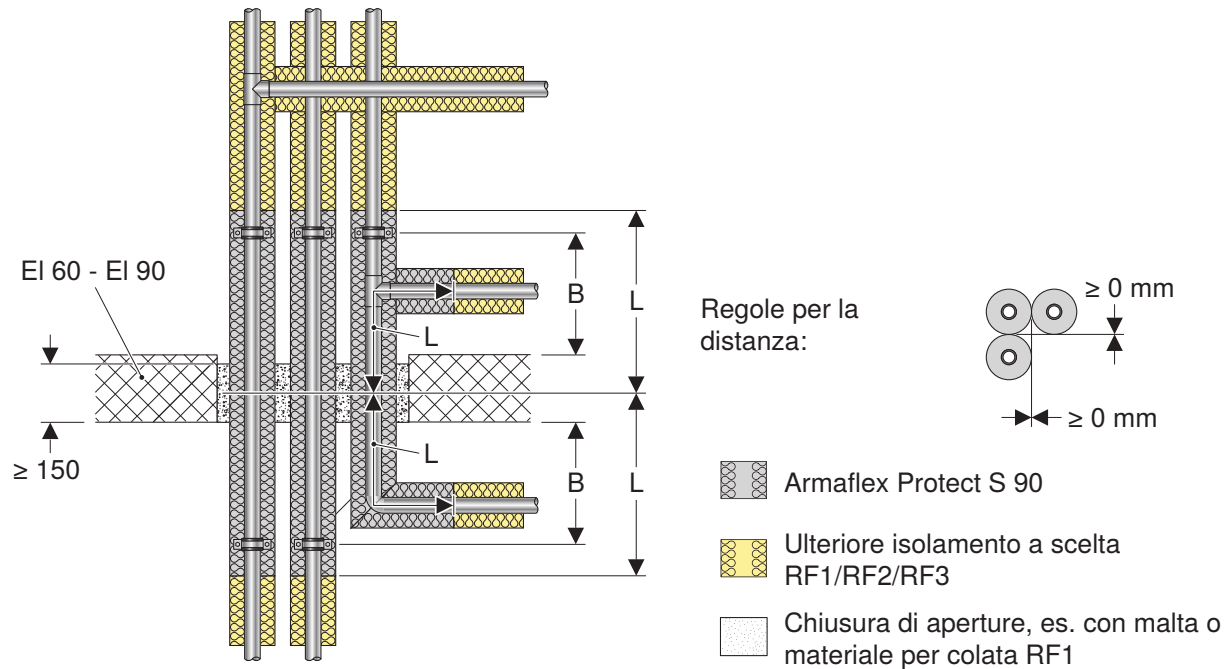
Attraversamento di soffitto con isolamento Geberit Mepla o Geberit PushFit e Armaflex Protect
